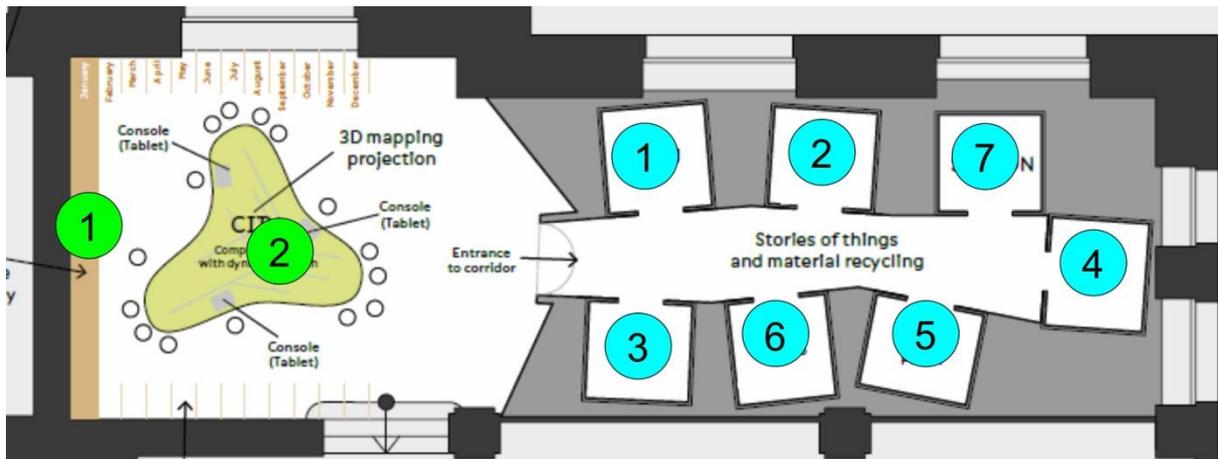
Grundriss und Stationsübersicht des nördlichen Flügels.
